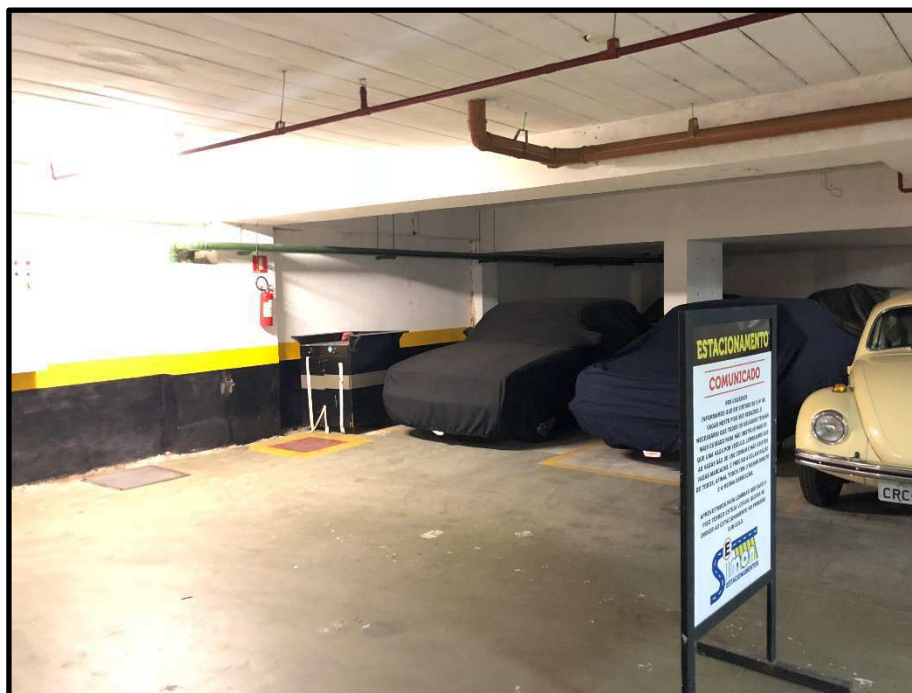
2º subsolo – vagas de garagem – Vista 4
